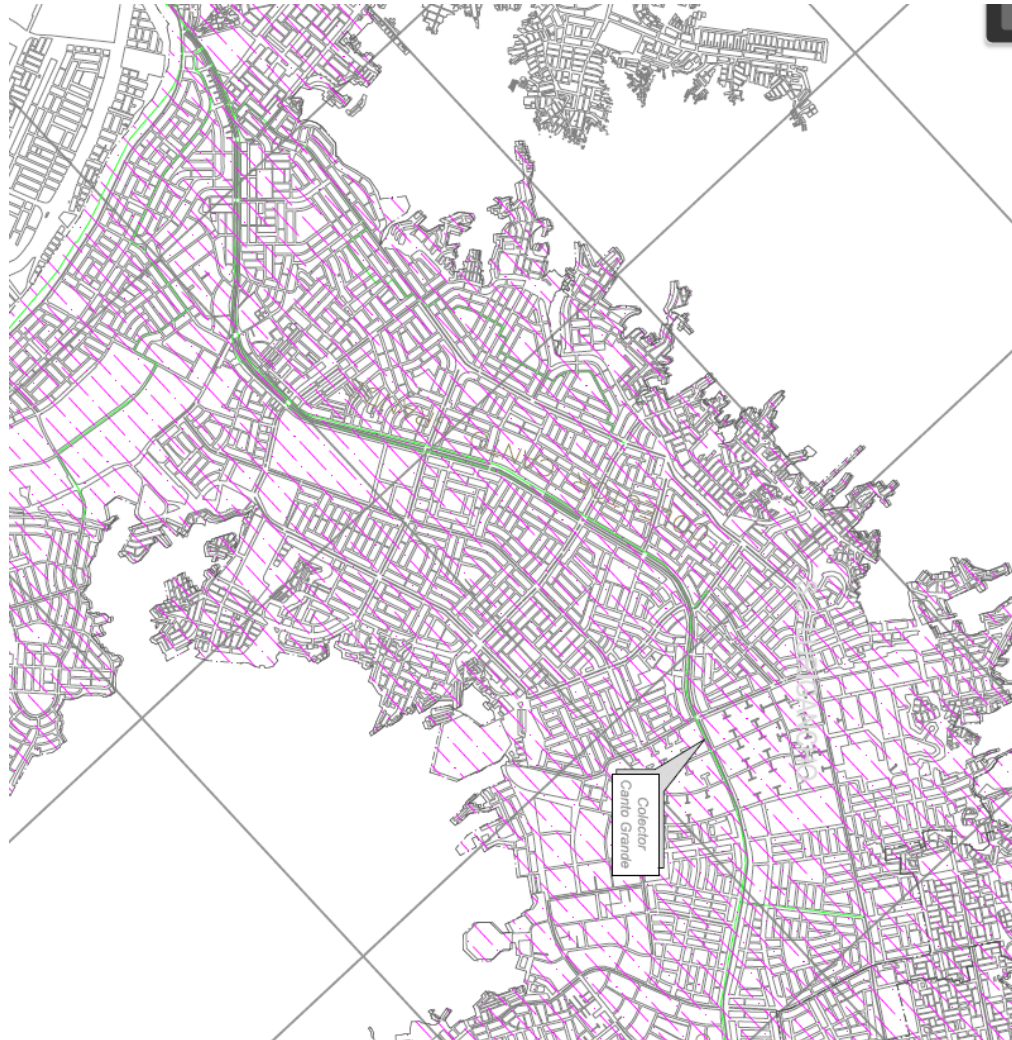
Plano del sistema de alcantarillado de SJL [15]
